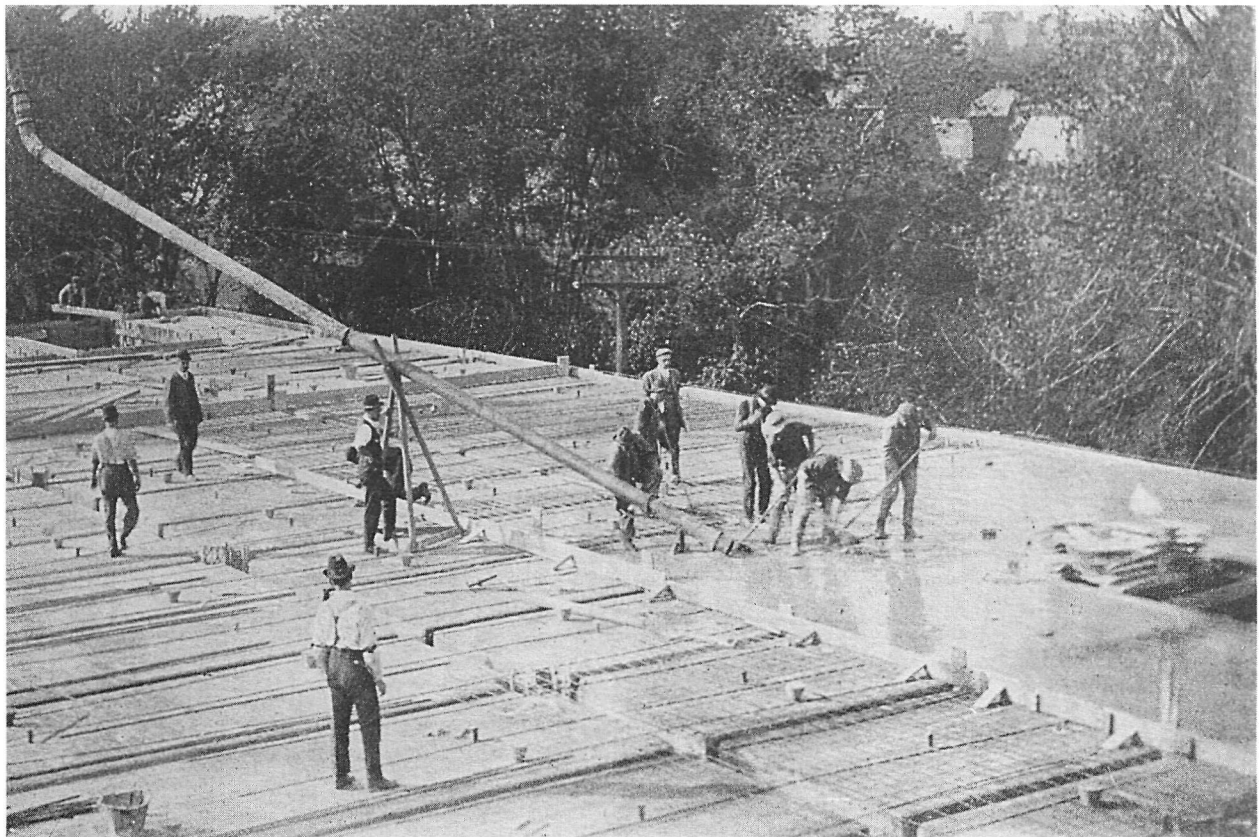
Jacobs Building en cours de construction, 1909, rue Sainte-Catherine, Montréal. Vue montrant l'ossature en voie d'être complétée. «Canada's Largest Concrete Building», Construction, vol. 3, no 4, March 1910, p. 59.
